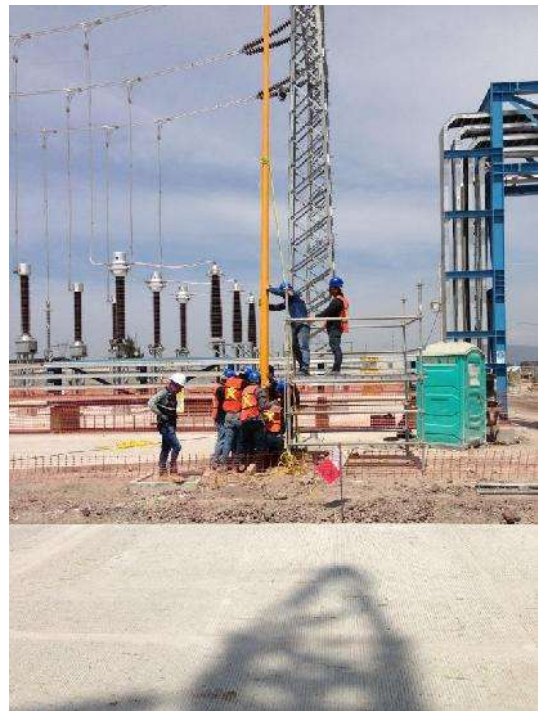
Instalación de Alumbrado Exterior Foto del Proyecto Salamanca
